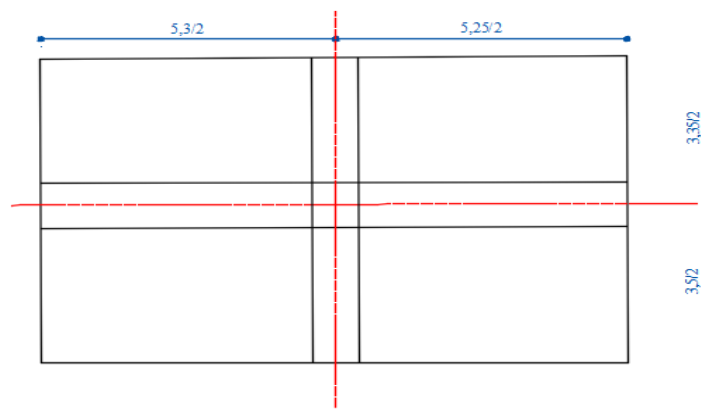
Schéma représentatif du poteau le plus sollicité.
